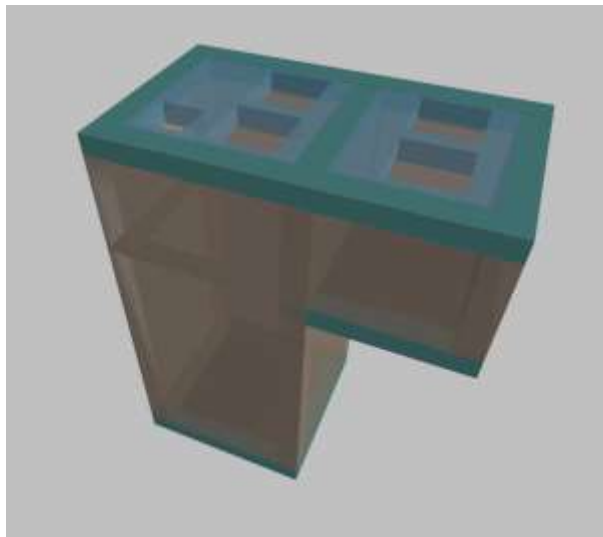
Pozo de saneamiento, Alternativa 1 y Alternativa 2.
